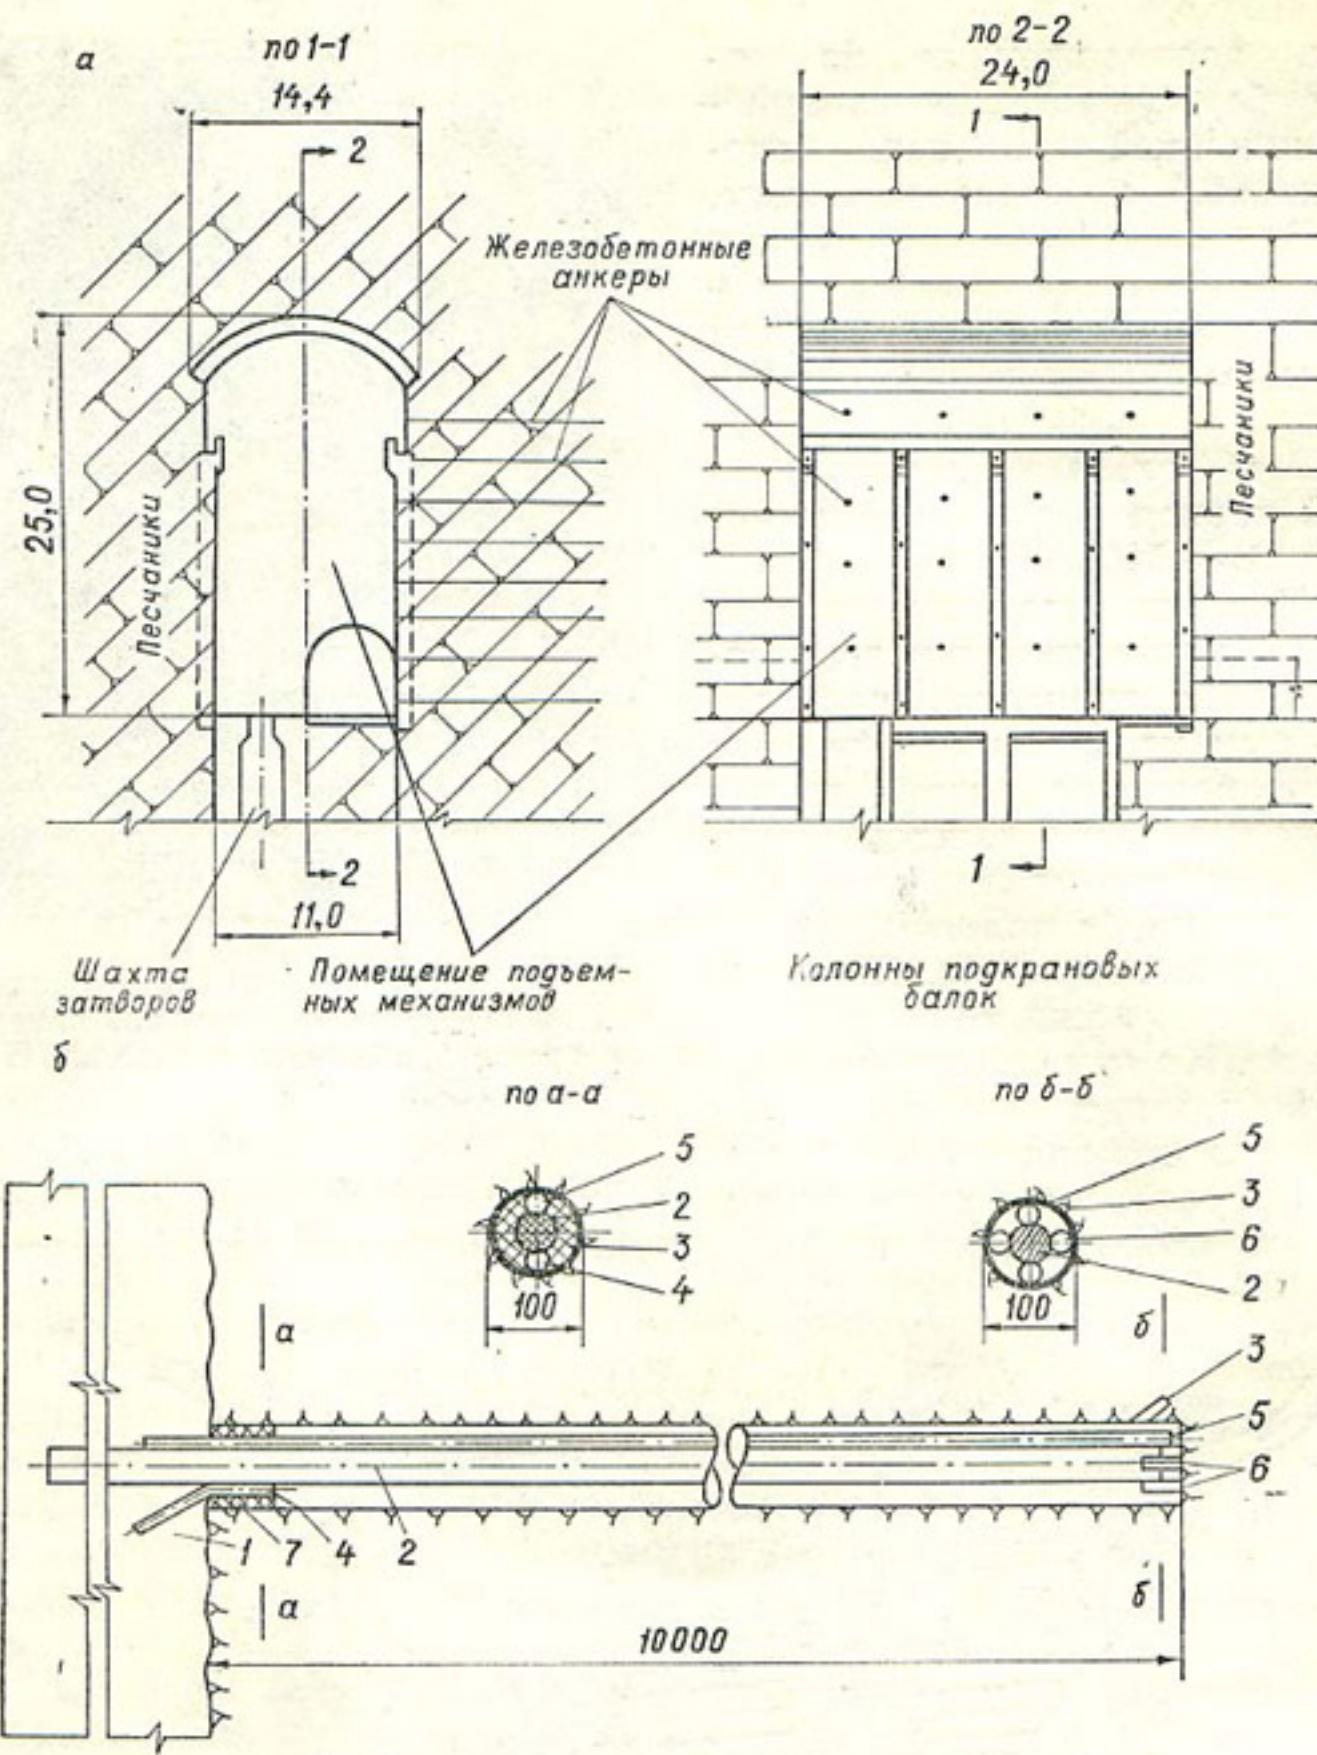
Укрепление стен помещения подземных механизмов затворов туннеля.
